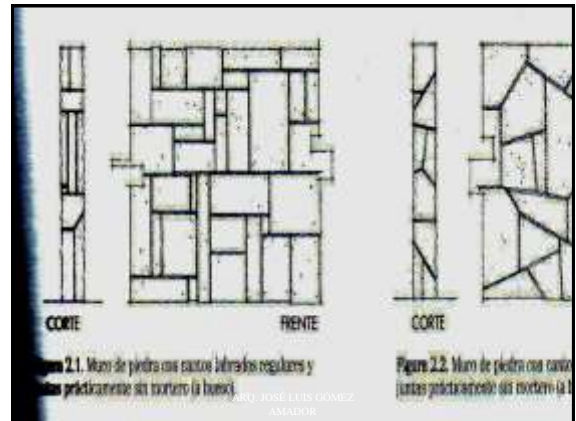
Muro de piedra con cantos labrados regulares y juntas prácticamente sin mortero (a hueso).
